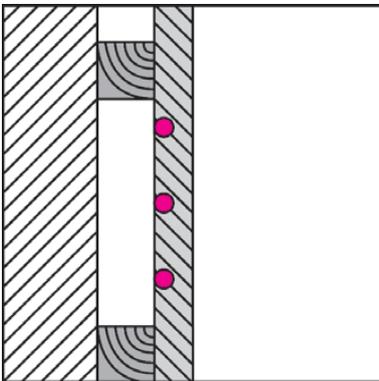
Wandheizung mit Verlegung der Heizrohre, direkt auf die Wand
